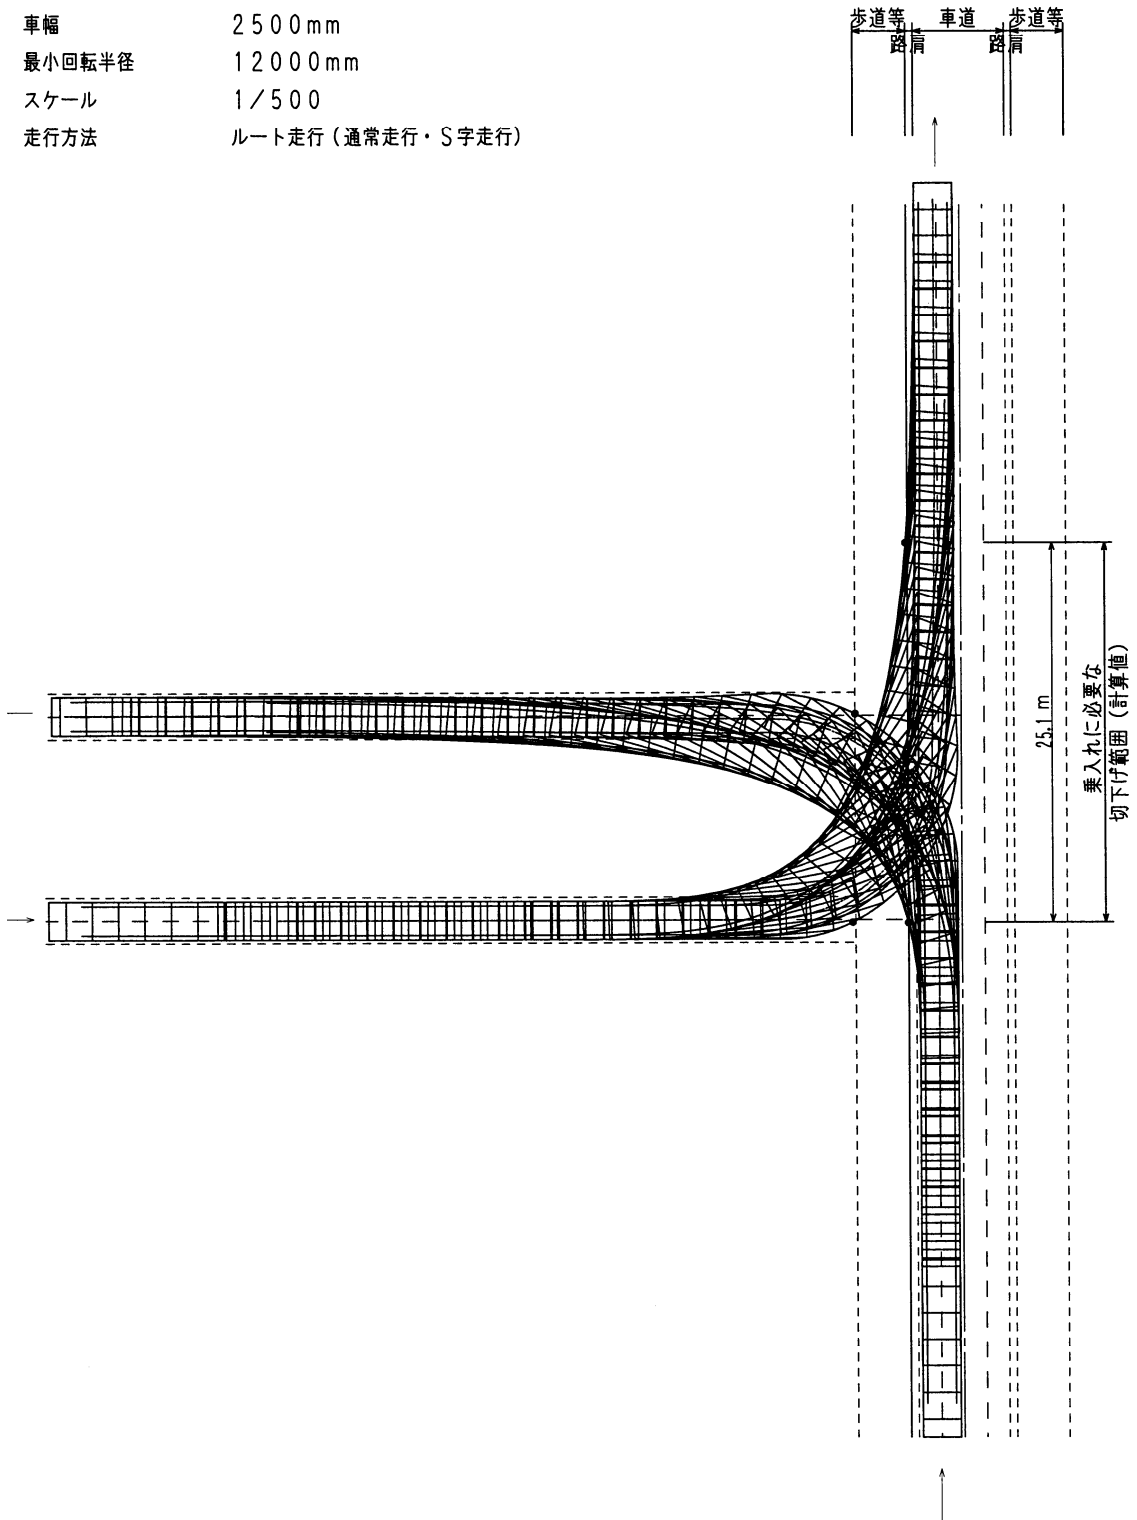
車道中央線より左側を使用(セミトレーラ)
